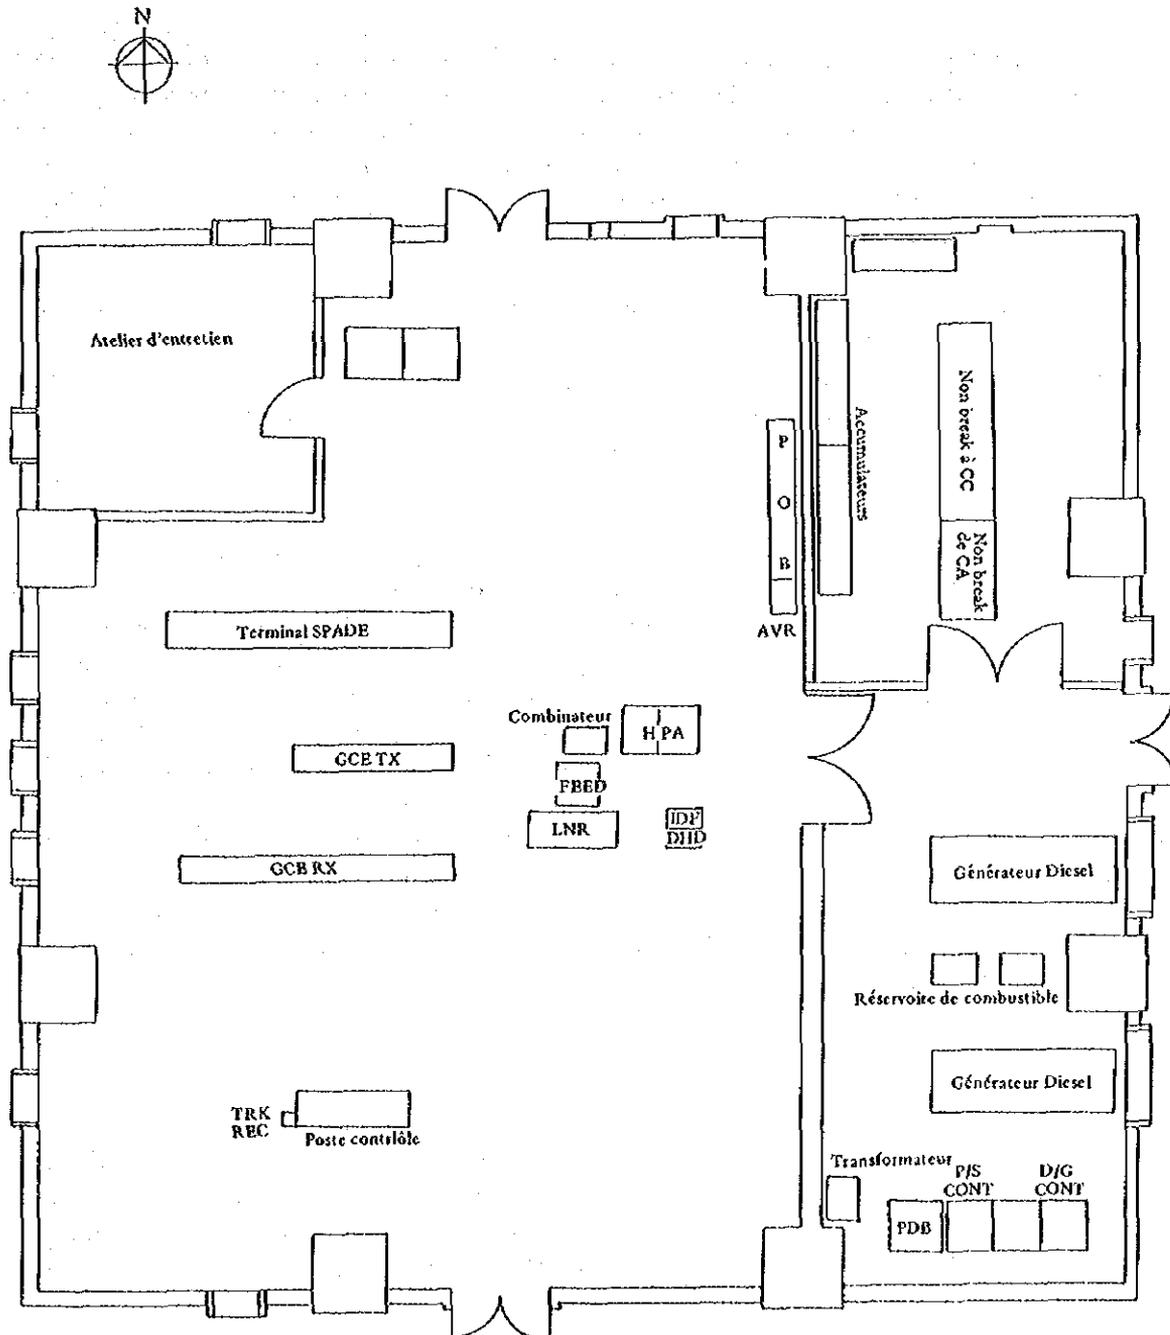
Plan d'installation à l'intérieur du piédestal de la seconde station terrienne
